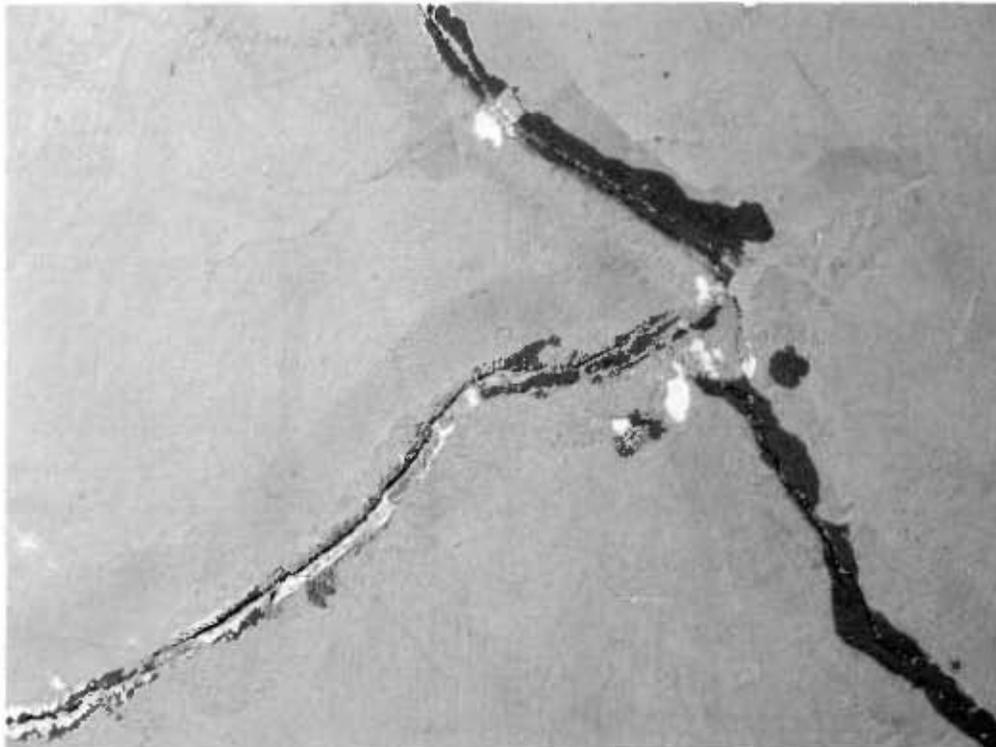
Grieta sobre sector reparado con anterioridad.
